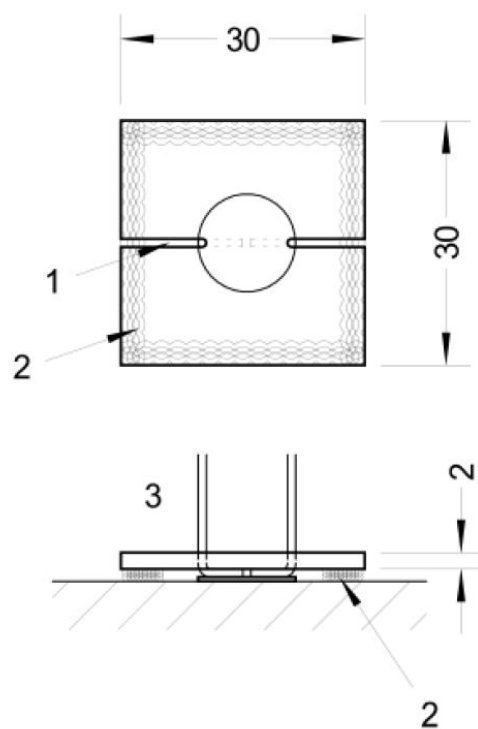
Schéma požárního experimentu – půdorys a řezy (červeně označeny spoje)
